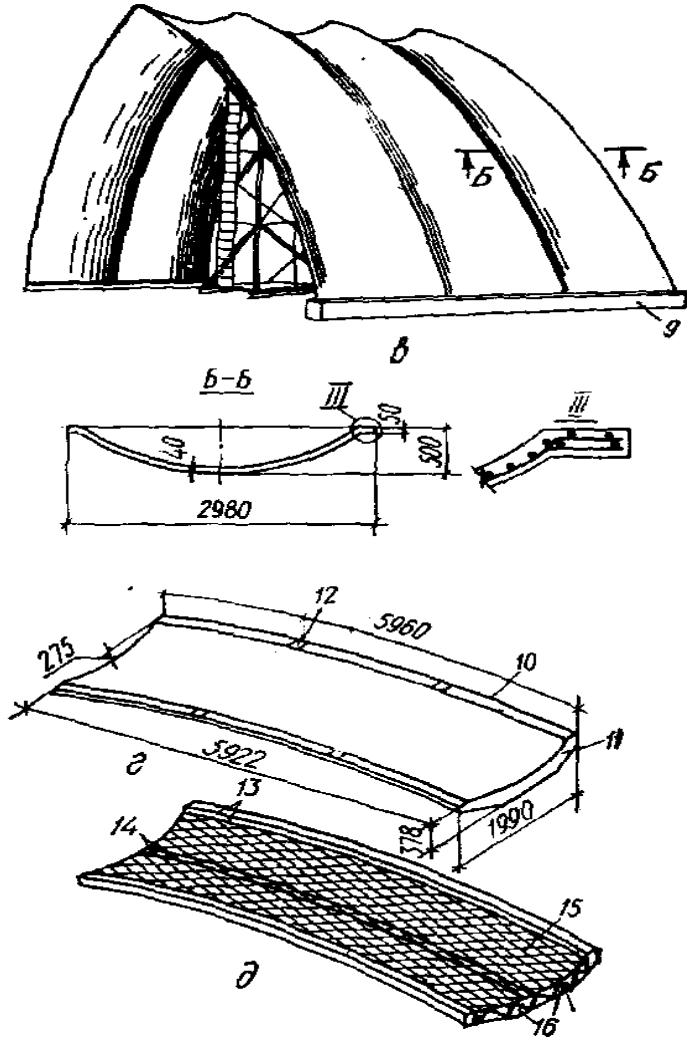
(продовження) – Хвилясті склепіння: *в* – з панелей-оболонок; *г* – збірна панель; *д* – армування збірної панелі; 1 – збірні елементи; 2 – з'яжка; 3 – підвіска; 4 – заповнення пазух; 5 – опорна балка; 6 - колона; 7 – вісь склепіння; 8 – вісь елемента; 9 – стрічковий фундамент; 10 – поздовжнє ребро; 11 – поперечне ребро; 12 – закладні деталі; 13 – стержні поздовжніх ребер; 14 – стержні в нижній частині хвилі; 15 – ромбувата сітка; 16 – каркас поперечного ребра
